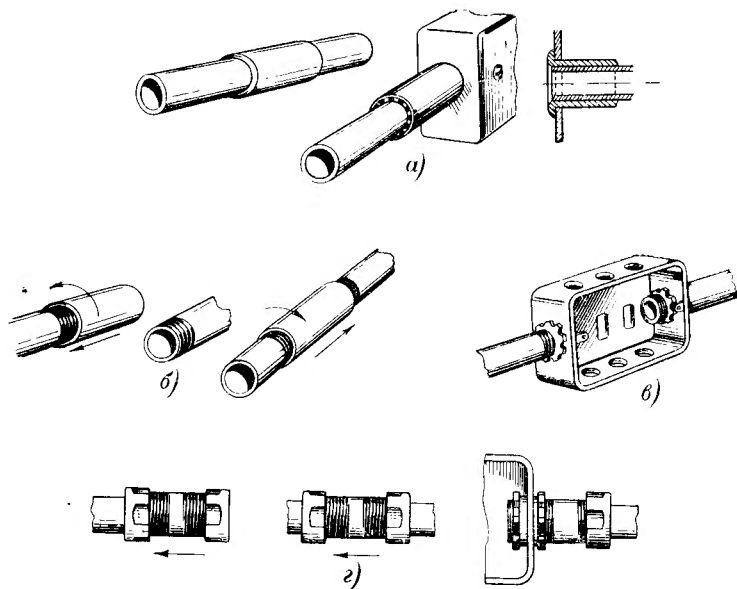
Соединения водогазопроводных труб между собой и с коробками. а — на сварке; б — на резьбе; в — царапающими гайками; г — муфтами с контргайками.
